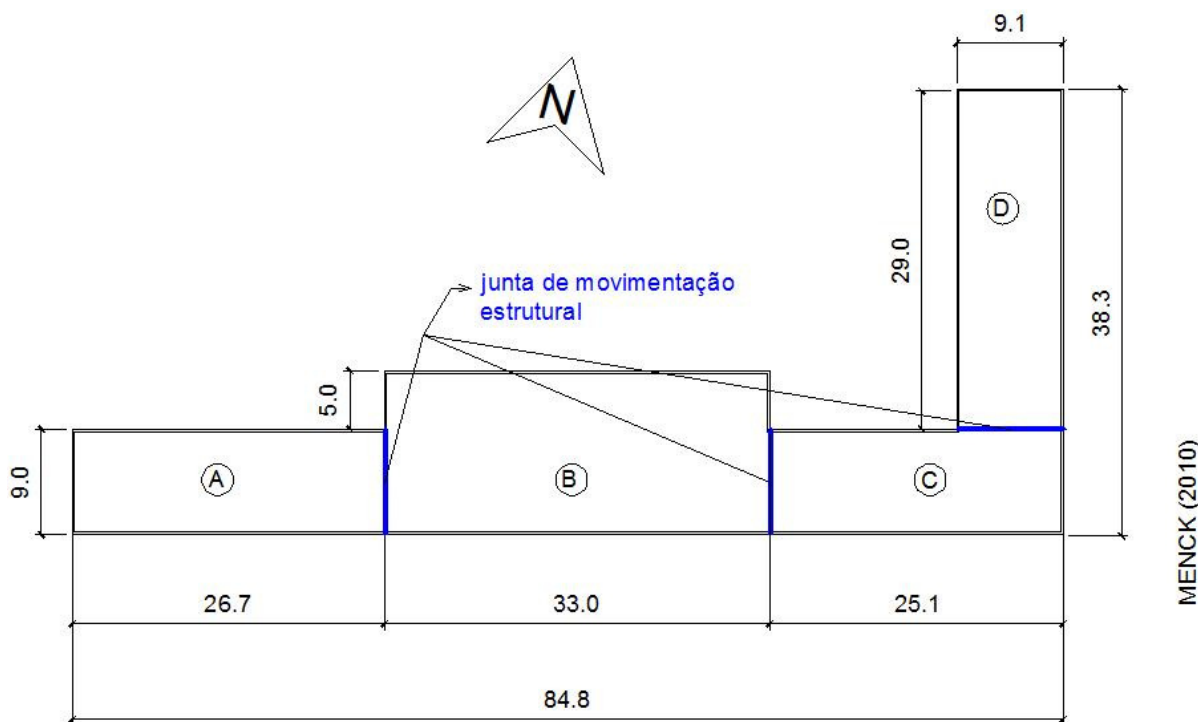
dimensões e posicionamento das juntas de movimentação estrutural
